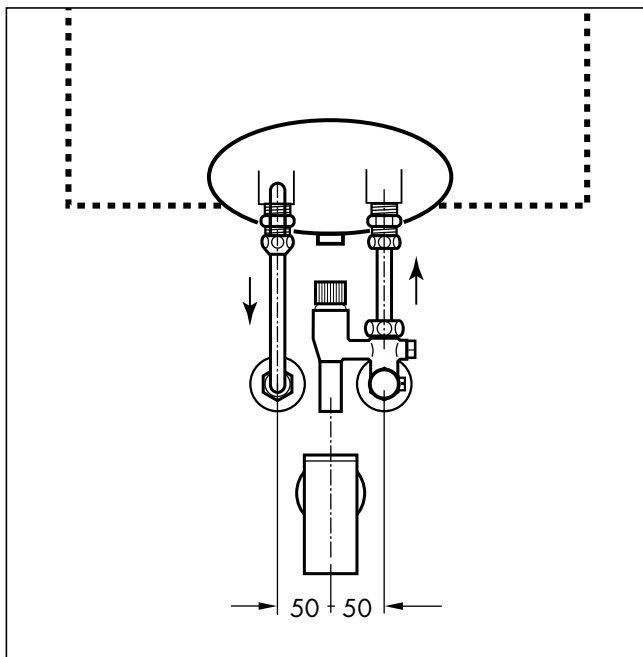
Vorderansicht bei geschlossenem System (Maße in mm)
